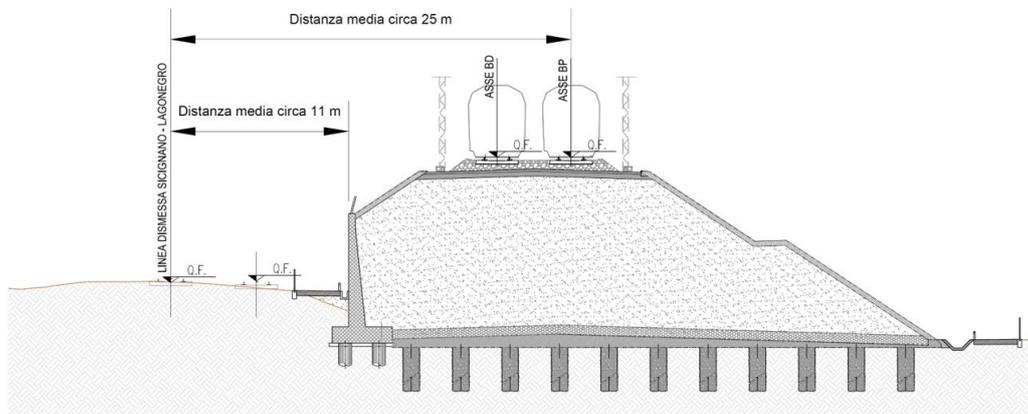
Sezione tipo in rilevato in corrispondenza dello stretto affiancamento
